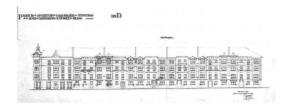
Vivienda colectiva del tipo D. Fachada principal.
